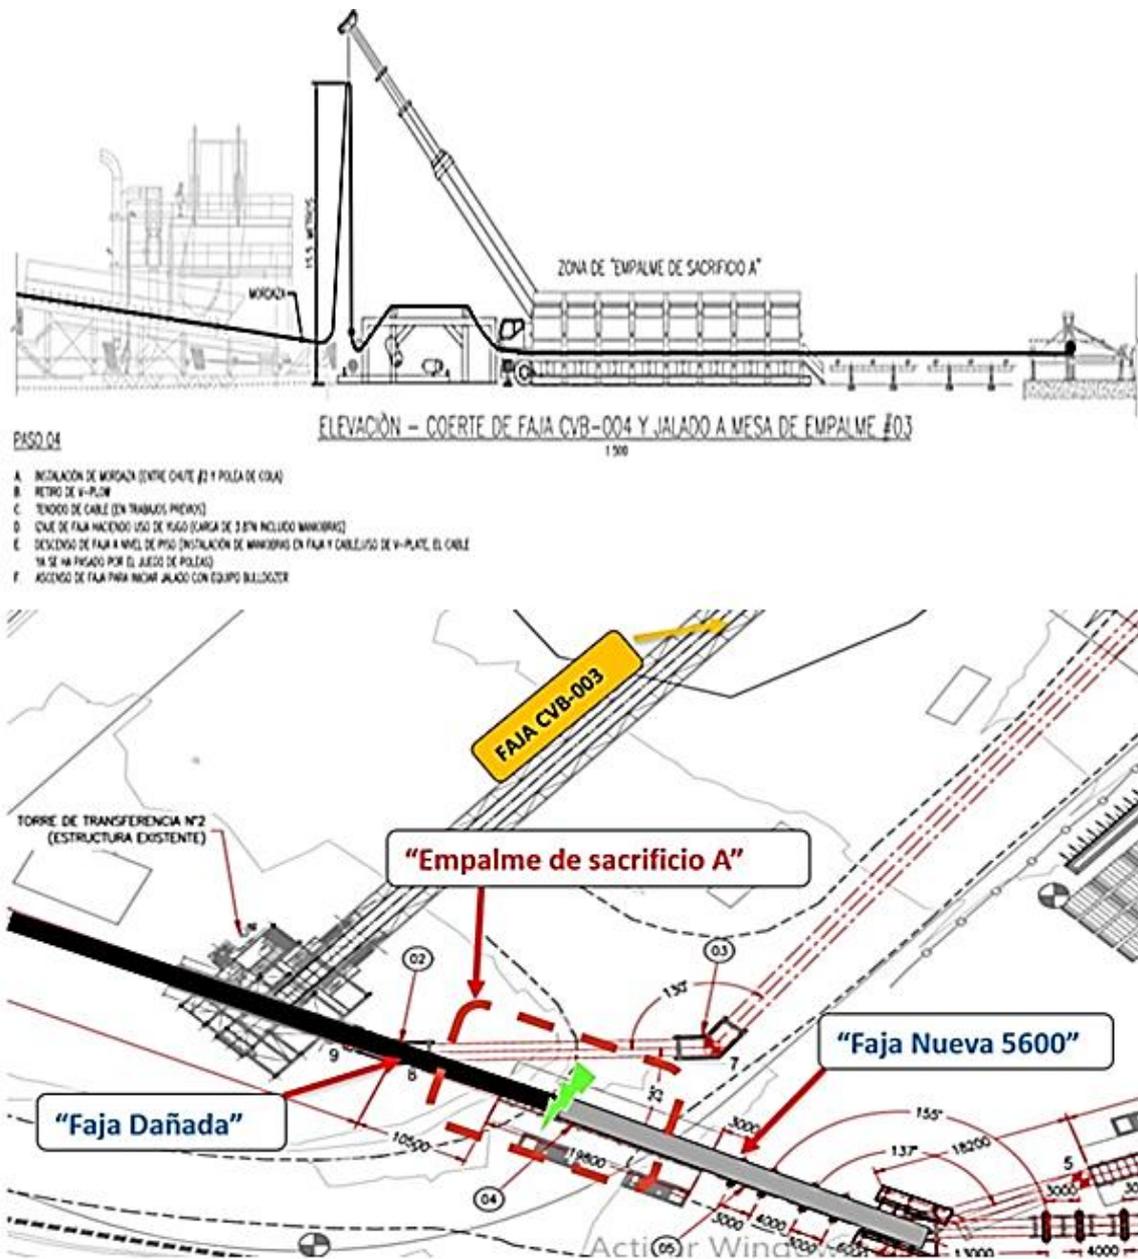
Vista de Planta y Elevación / ubicación “Empalme de sacrificio A”.
